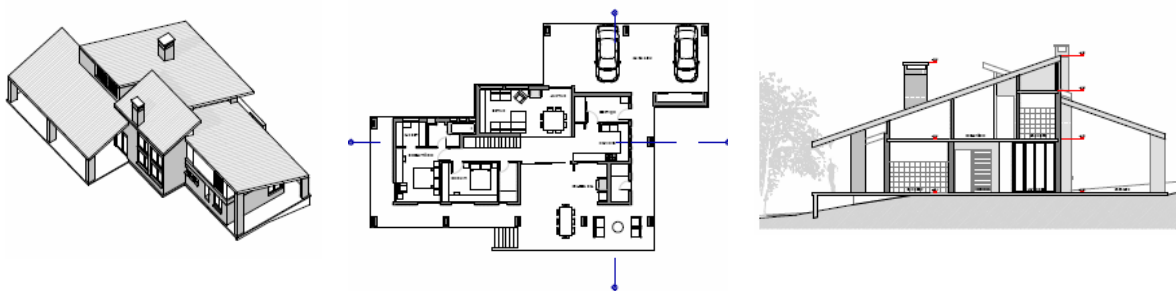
Exemplo de projeto realizado no ArchiCad. Modelo virtual, planta baixa e corte.
